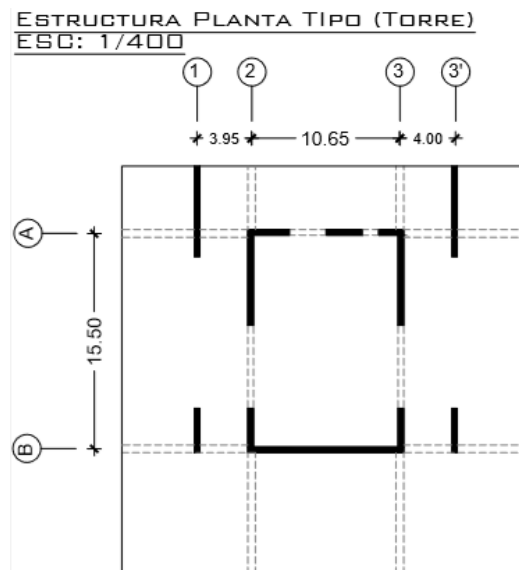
Estructura Planta Tipo de Torre de Oficinas. Fuente: Adrian Colombet. (2020)
